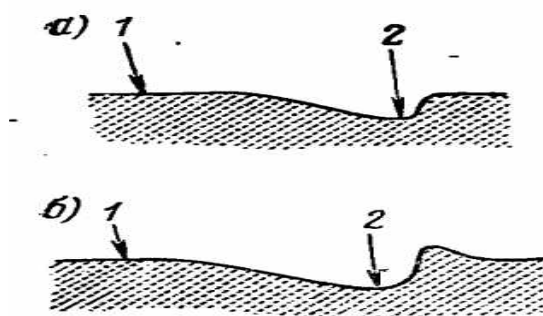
Поперечний перетин вм'ятини цементобетонного (а) і
